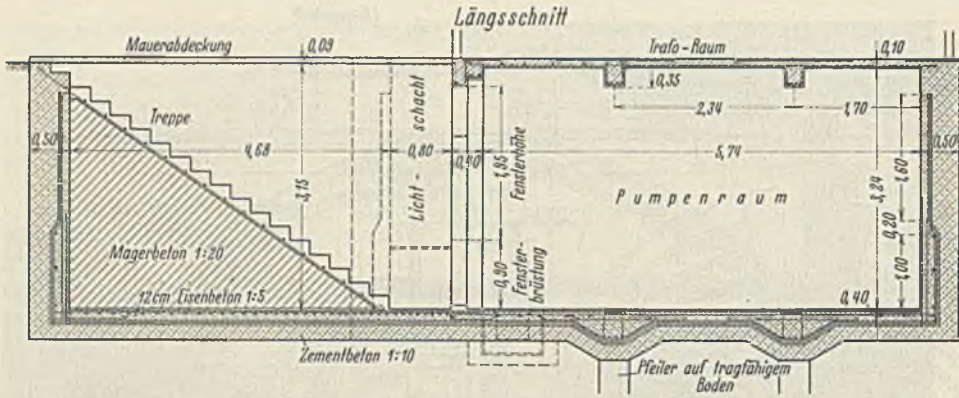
Wasserdichter Pumpenraum in der südlichen Auskleidehalle. Maßstab 1 : 100.
